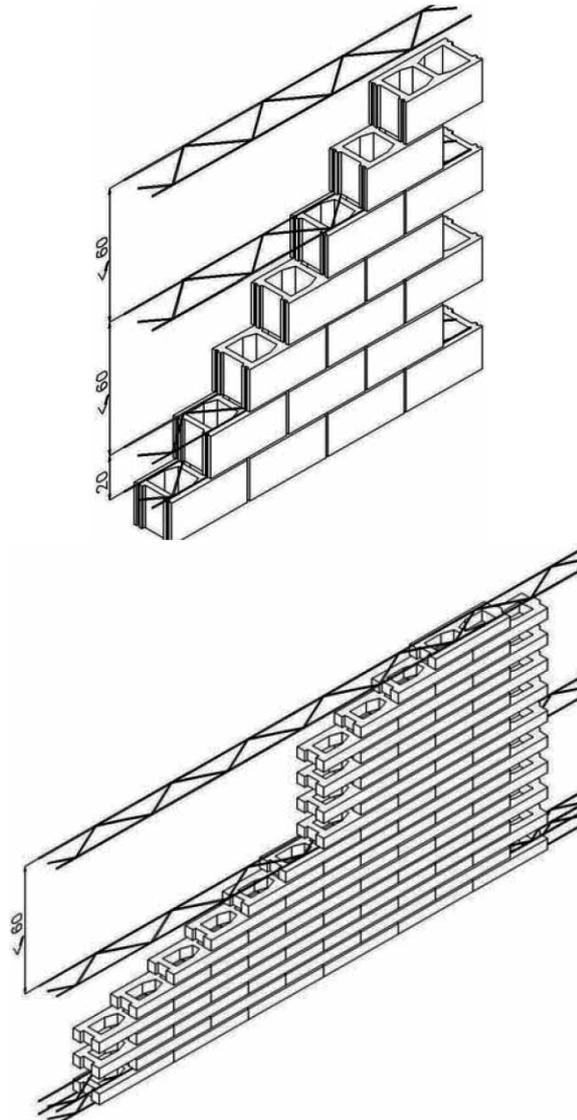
Muros de fábrica armada con armadura de tendel prefabricada de una hoja con bloque de hormigón hueco y con ladrillo de hormigón alargado.
